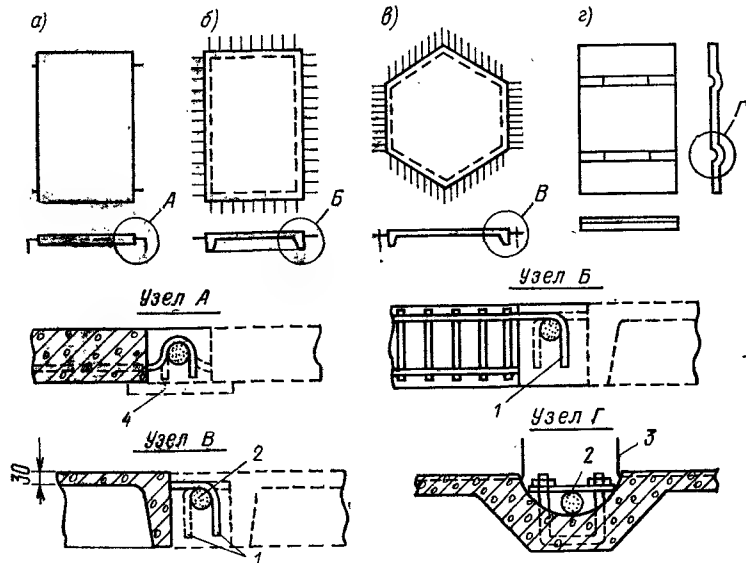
Типы сборных железобетонных плит (а—г) для одноярусных висячих покрытий
